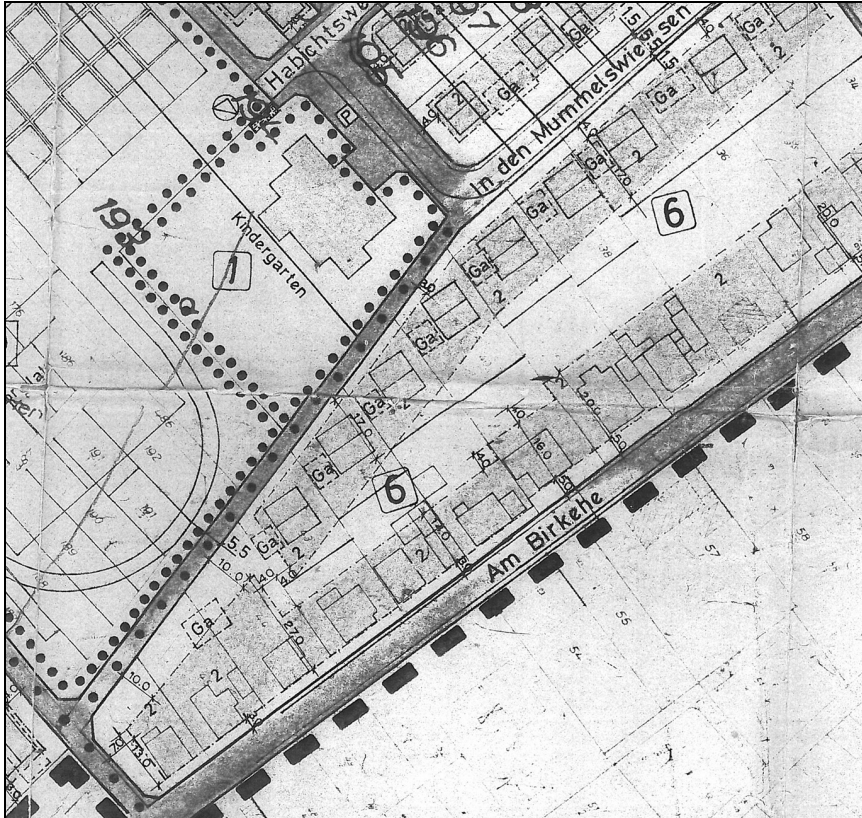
Bebauungsplan „In den Mummelswiesen“ - Ausschnitt - (o.M.)
